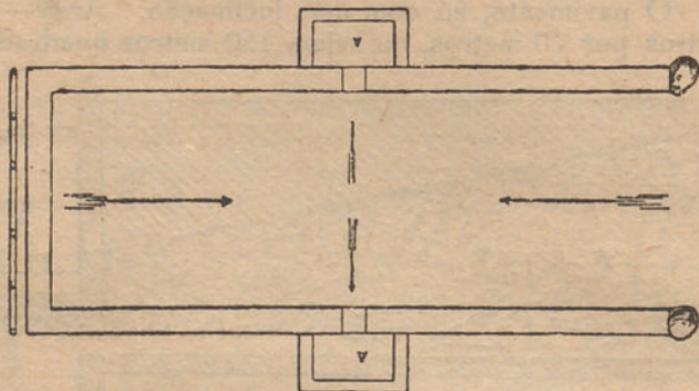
Estrumeira de rampa, em dois planos—Planta
